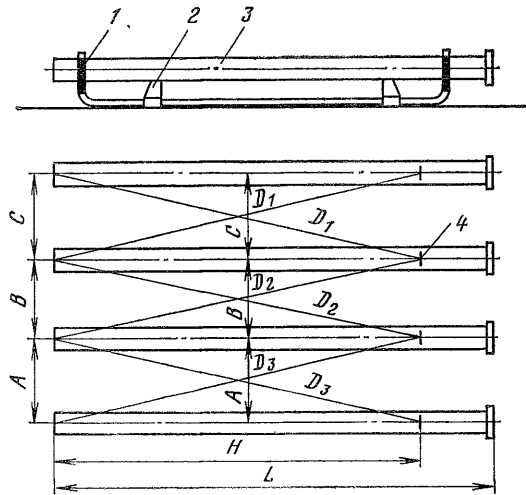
Выверка положения колонн при сборке блока каркаса.
